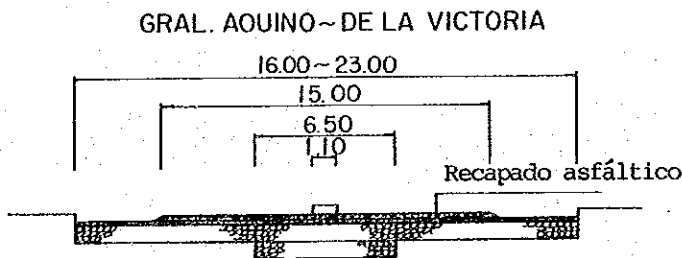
ESTADO DE PAVIMENTACION DE LA AV.M.LYNCH
